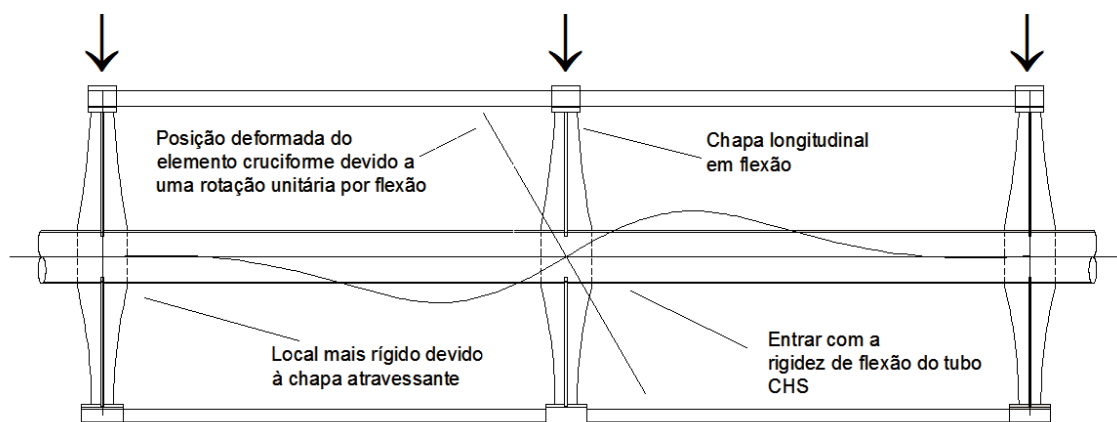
Configuração deformada da treliça Vierendeel devido a uma rotação no plano da estrutura
